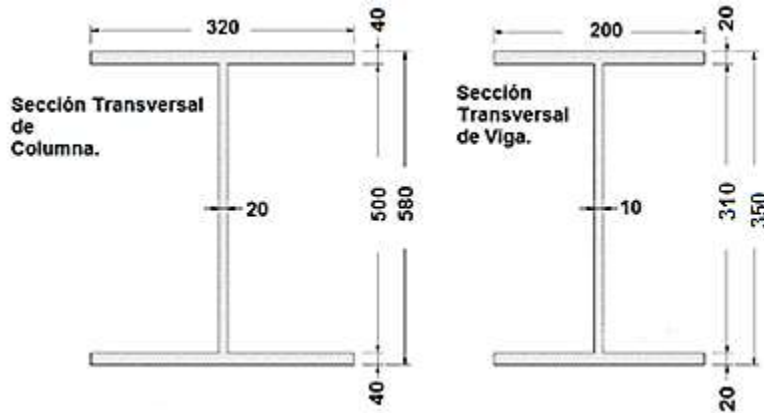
Dimensiones de columna y viga en la conexión (medidas en mm).
